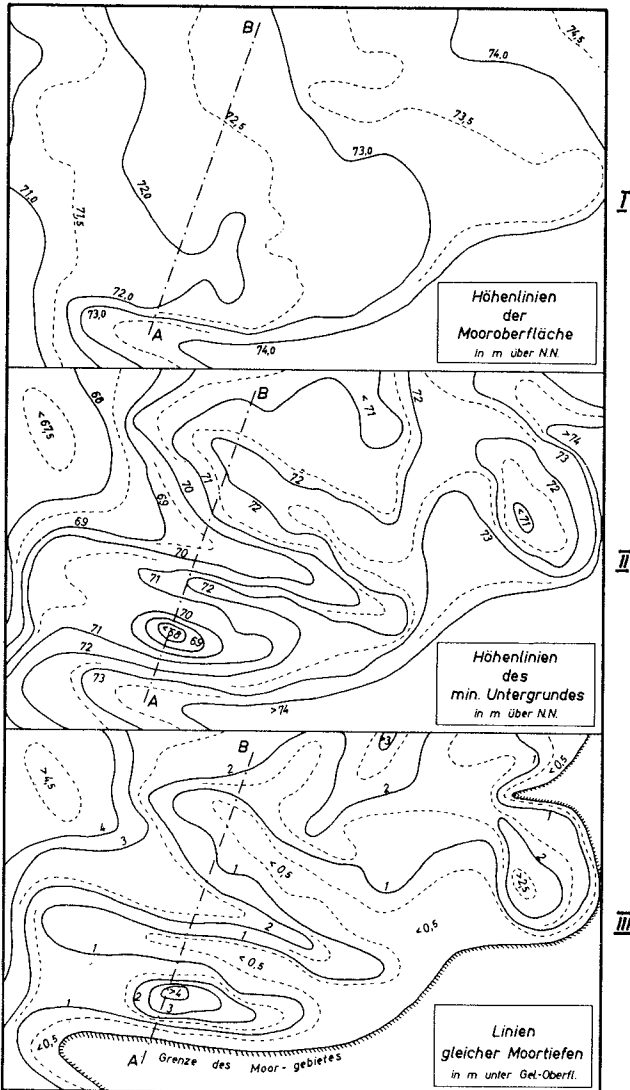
Lageplan einer Moorfläche [3.2] (Schnitt A–B s. Bild 3.3 und 3.7)
